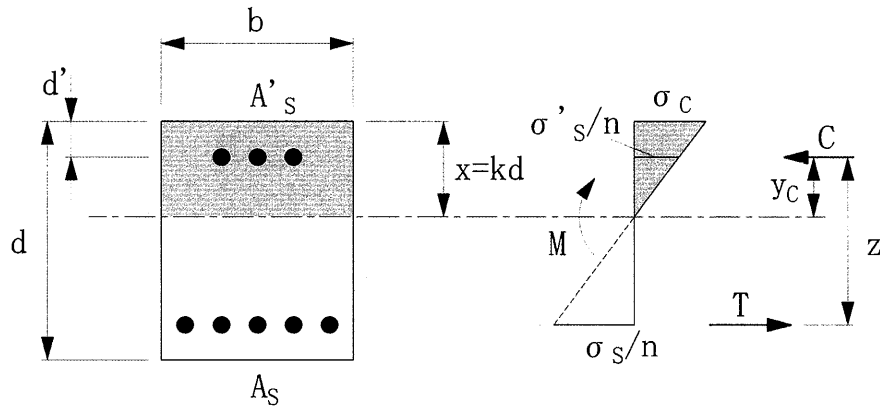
2軸複鉄筋断面の鉄筋コンクリート断面
